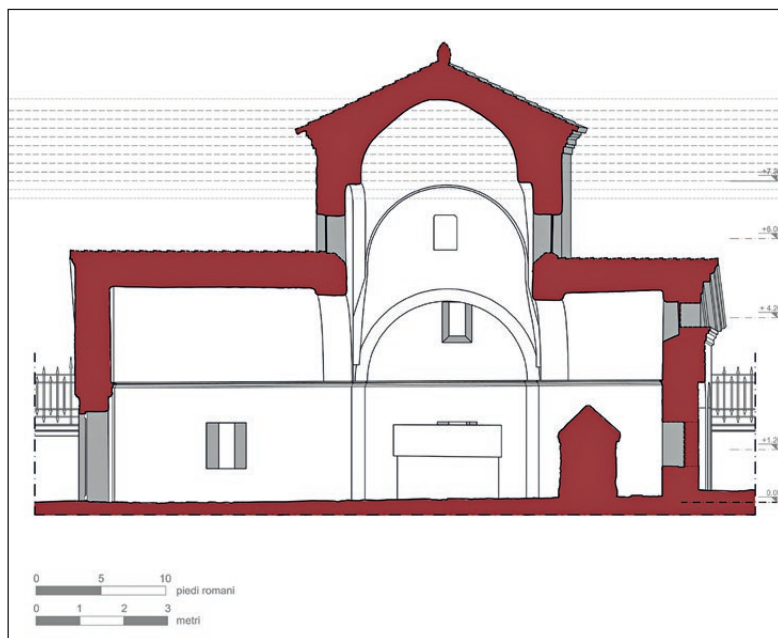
Sezione longitudinale (l'elaborato è stato prodotto a partire dalla restituzione di G. Lavoratti).
